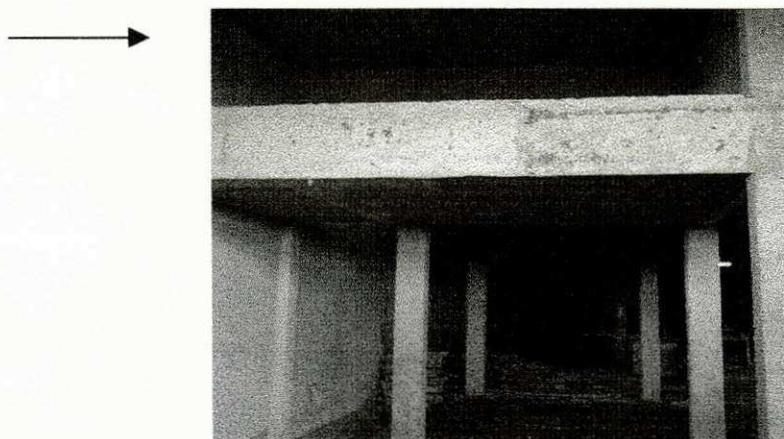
Laje onde ficará casa de máquinas da piscina
